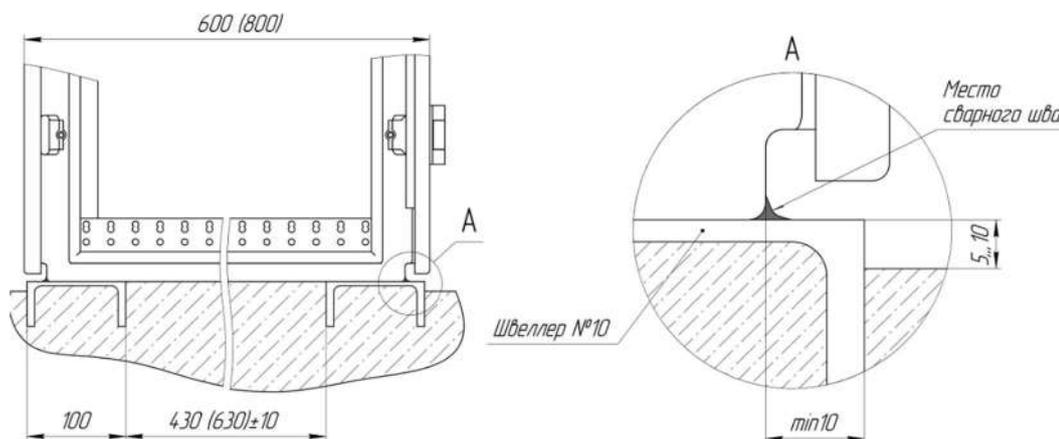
Крепление ШРОТ к закладным элементам при помощи сварки
